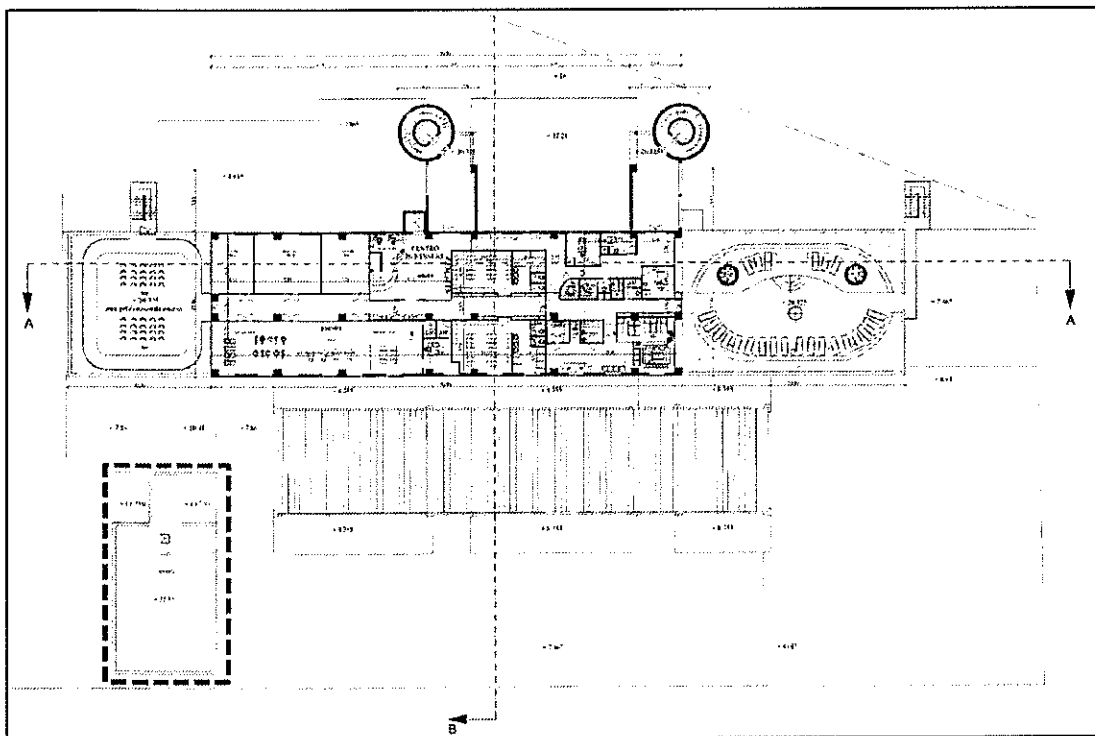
Progetto del piano sesto estratto dalla tavola allegata al PdC n. 59/2013.
